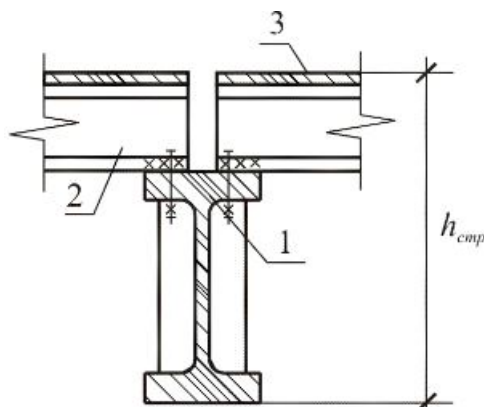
Узел опирания балки настила на главную балку (этажное опирание балок):
